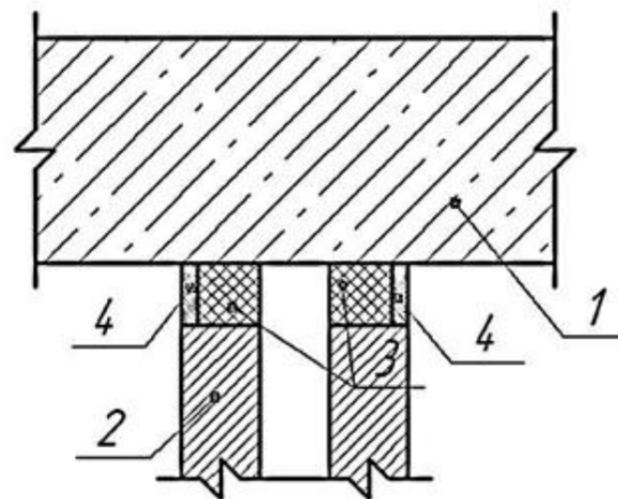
Схема конструктивного решения узла примыкания двойной перегородки к перекрытию:
